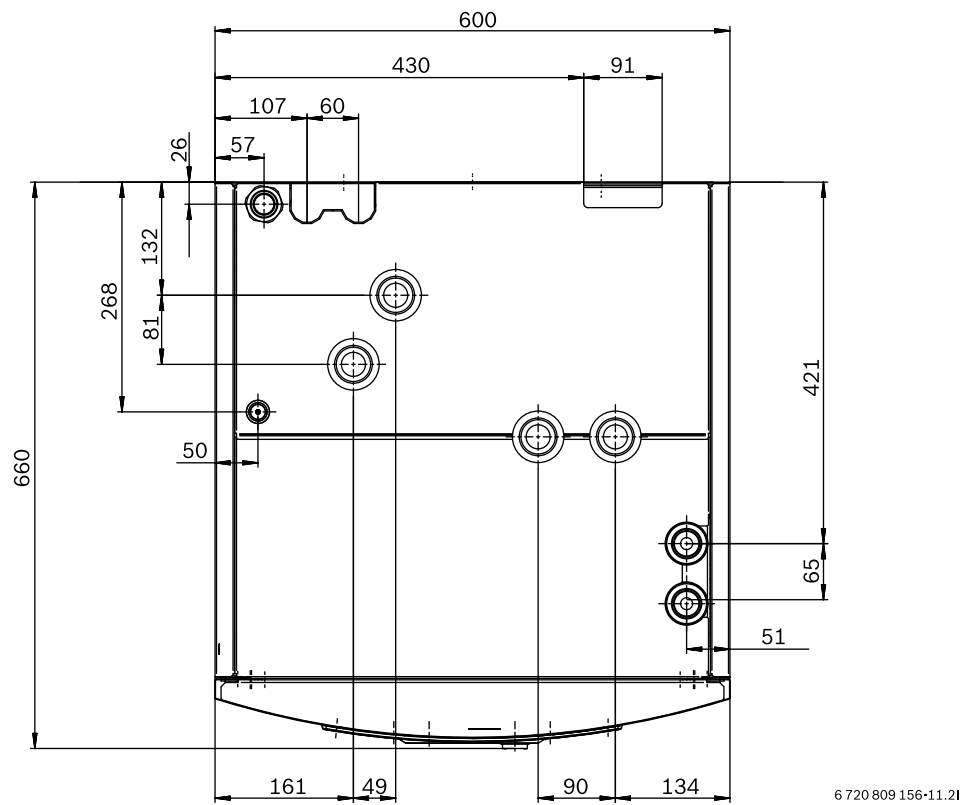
Medidas del ACM, vista en planta (medidas en mm)
